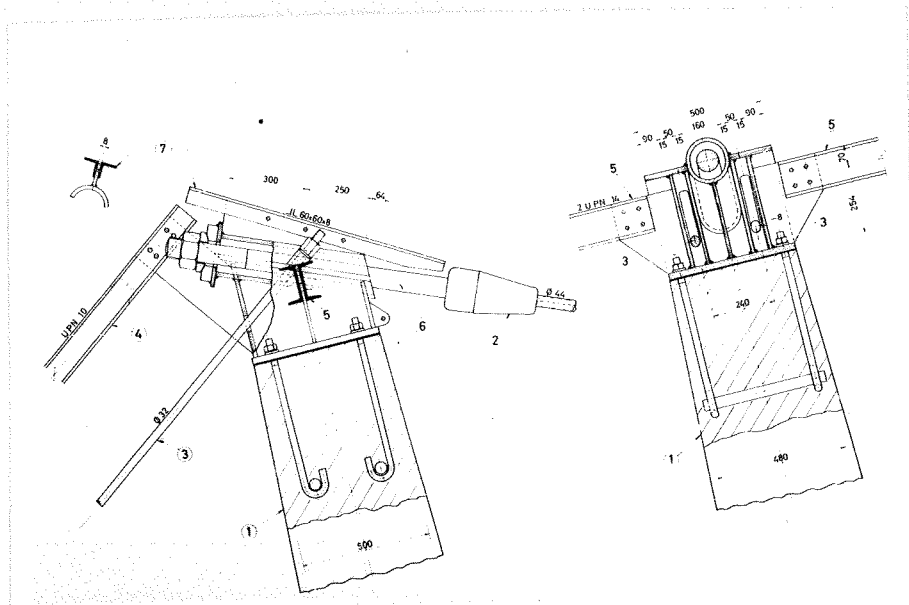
Dispositivo pré-fabricado para o arranque dos cabos portantes e dos tirantes. 1) pilar em concreto; 2) Esticador do cabo portante; 3) Barra Dywidag; 4) Perfilados formando a parte mais inclinada do cavalete; 6) Tubo  $\phi$  81; 7) Cantoneiras colocadas após a protensão dos cabos.
